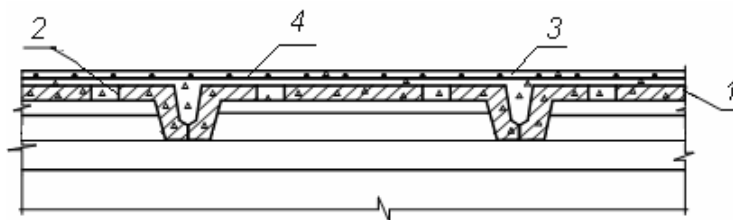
Усиление сжатой зоны сборных плит наращиванием: 1 – усиливаемая плита, 2 – шпонки, 3 – бетон наращивания, 4 – арматура наращивания
